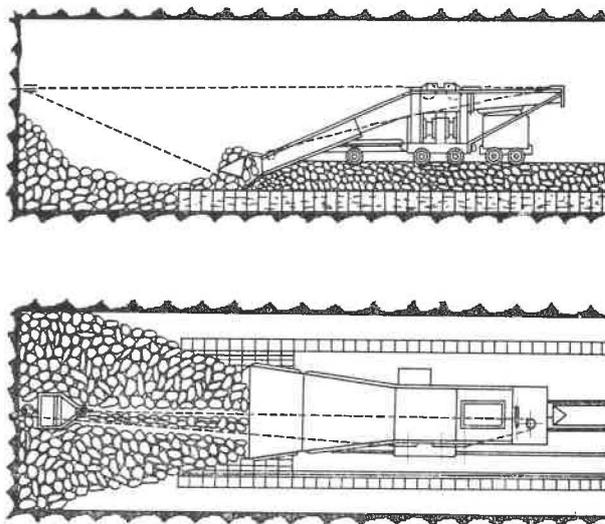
Installation de chargement par scraper-houe en bouveau à claveaux. — Au-dessus : vue en élévation. En dessous : vue en plan.
